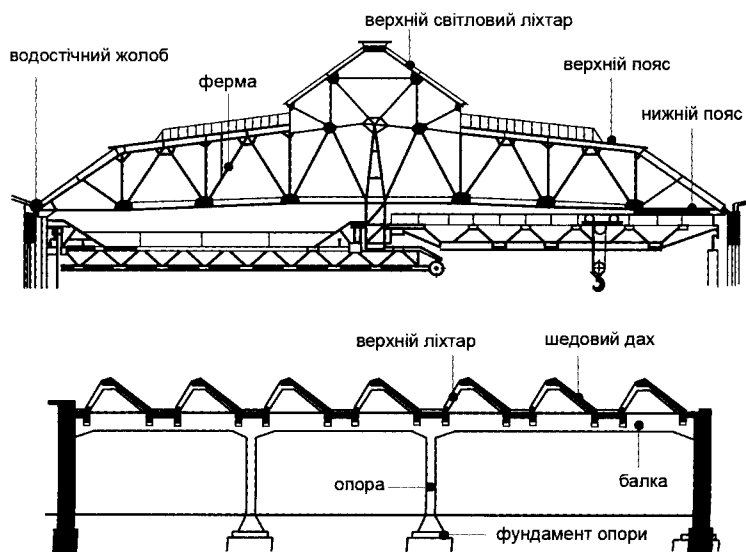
Конструкції ферм для промислових будівель та споруд
